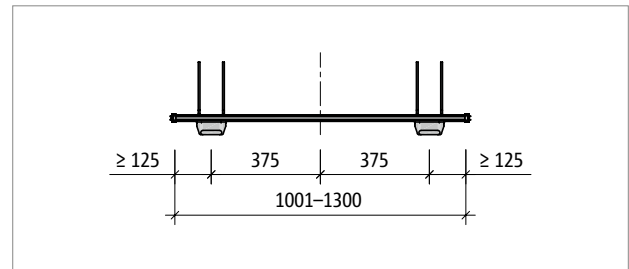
Schöck Tronsole® Typ T-V2...-L1001 bis L1300: Produktgrundriss
